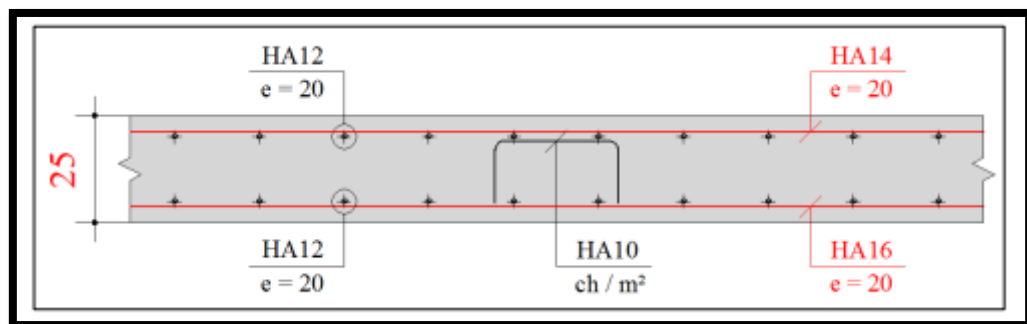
Ferrailage de la dalle (coupe transversales)
